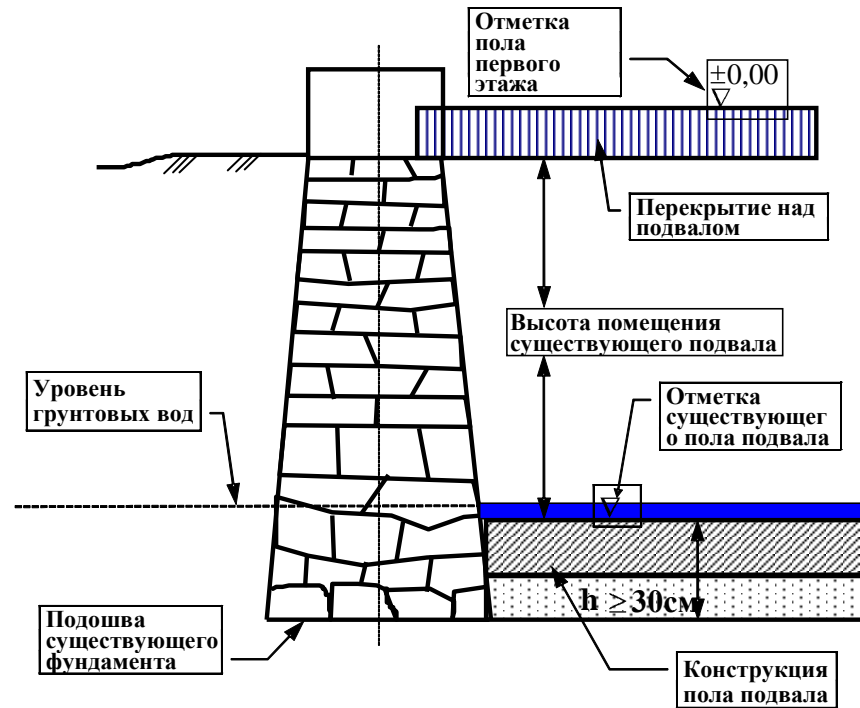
Типичный конструктивный разрез фундамента с подвальным помещением и разрушенной гидроизоляцией при высоком уровне грунтовых вод (У.Г.В.)
